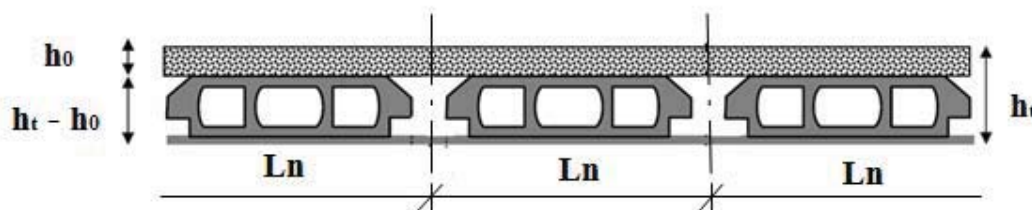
Coupe transversale d'un plancher à corps creux.
